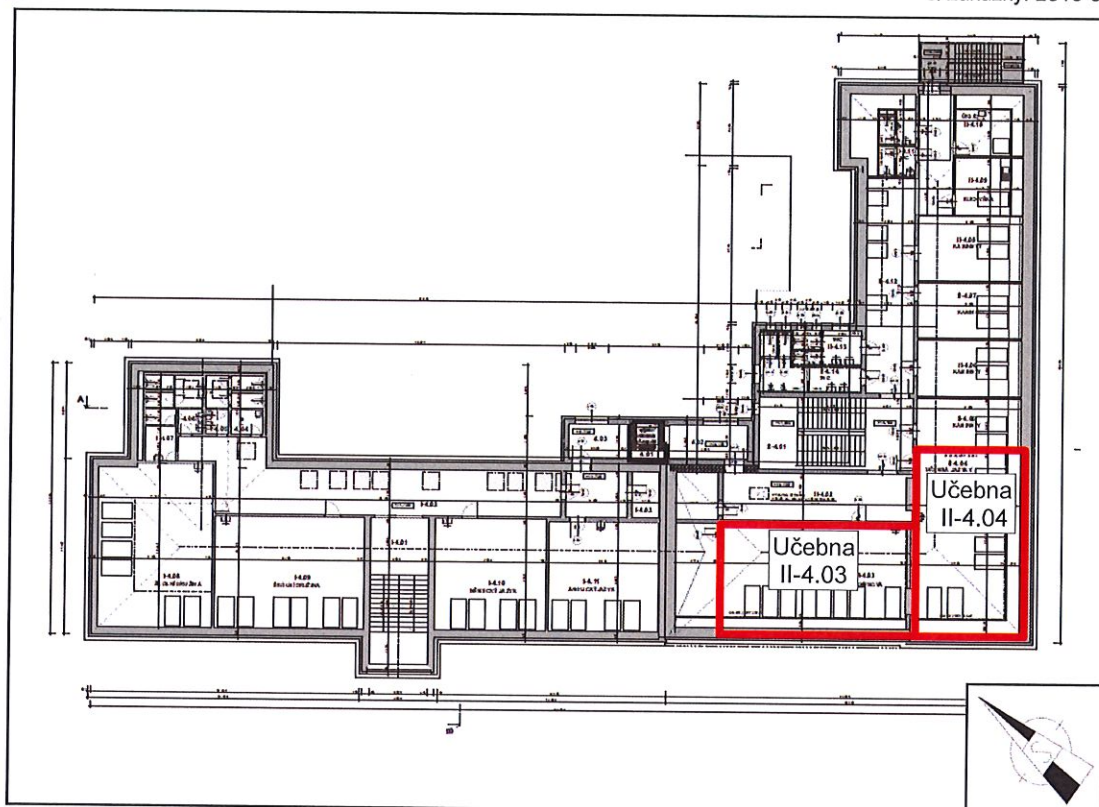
Půdorys 1.NP v navrhovaném stavu
